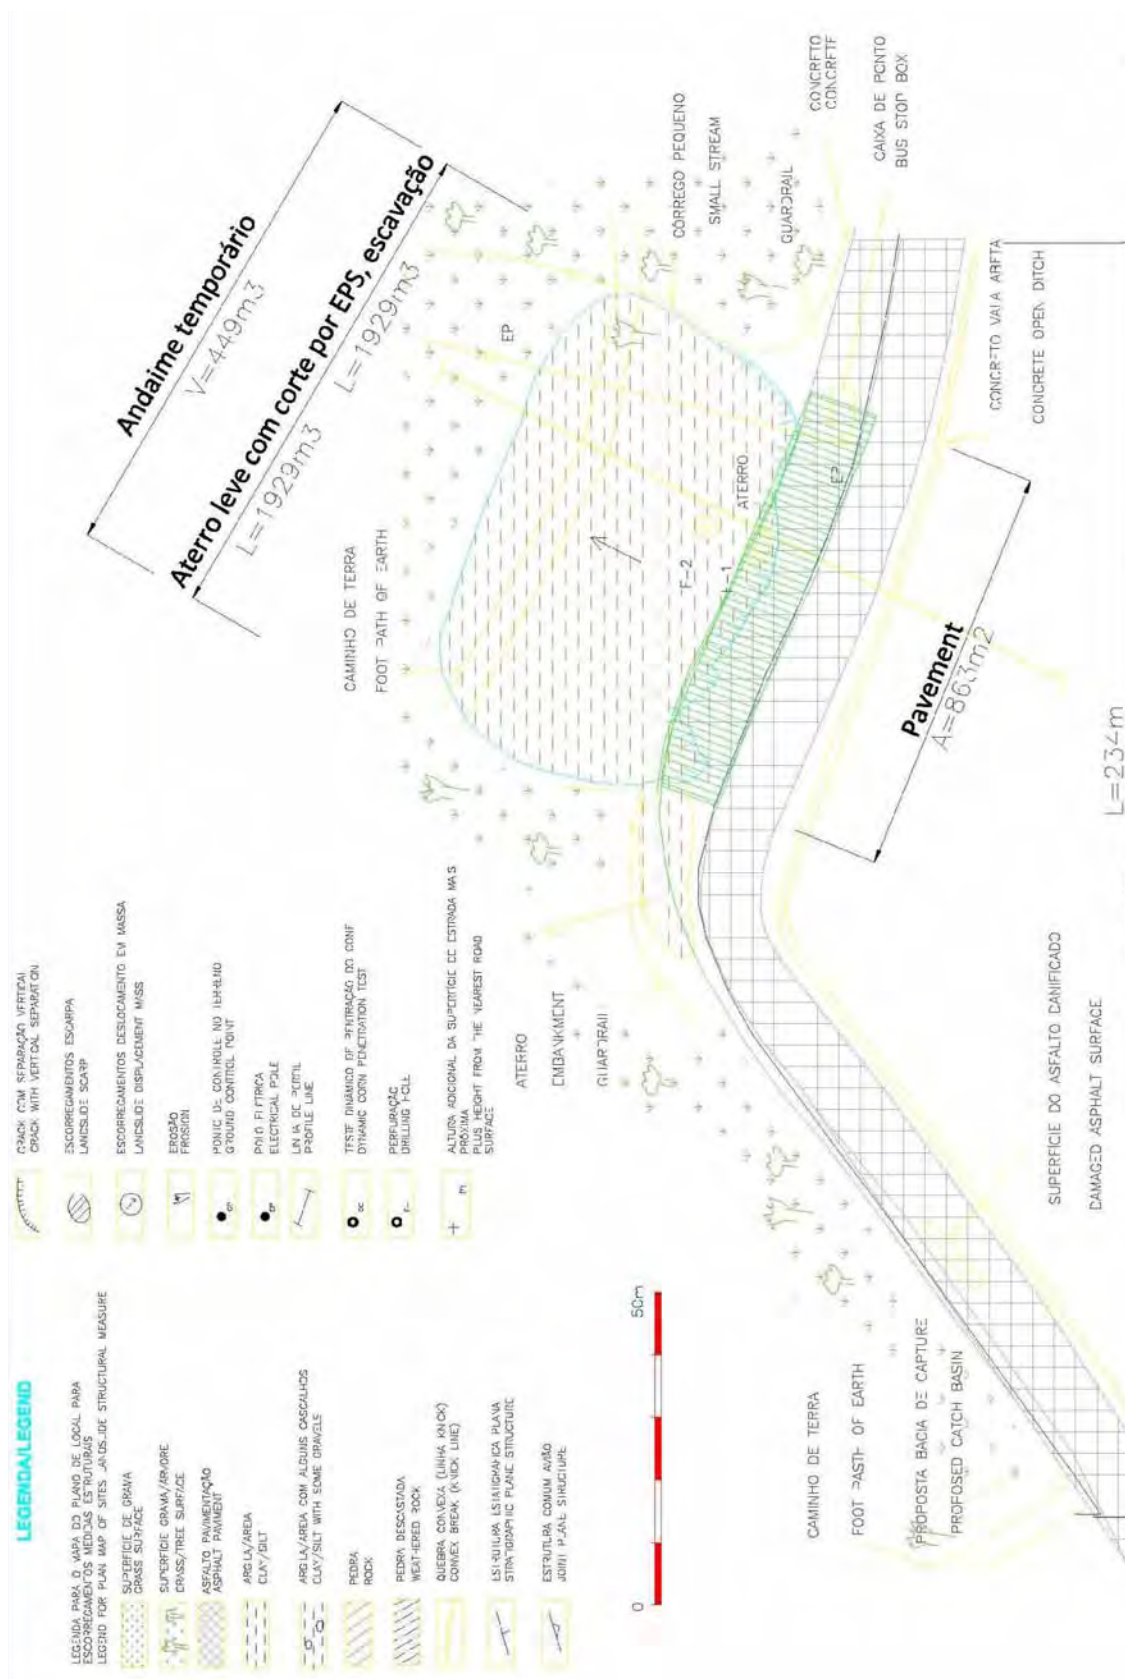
Planta baixa da medida estrutural para a prioridade No.5 SC474 Blumenau - Massaranduba 2
